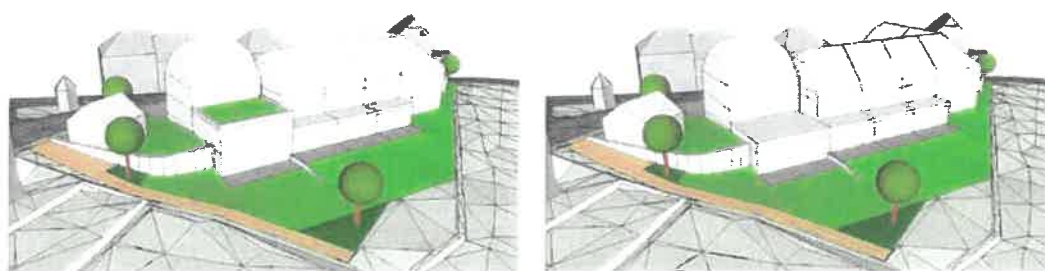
construction secondaire admise lot 1 (source : BEST)
